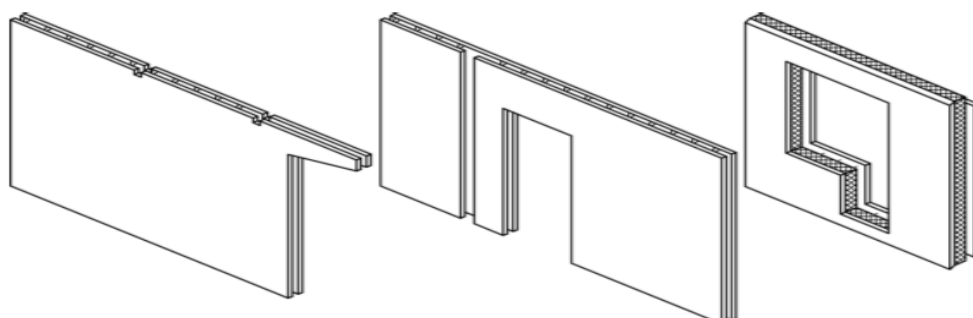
Конструкция сборных железобетонных элементов несъемной опалубки
